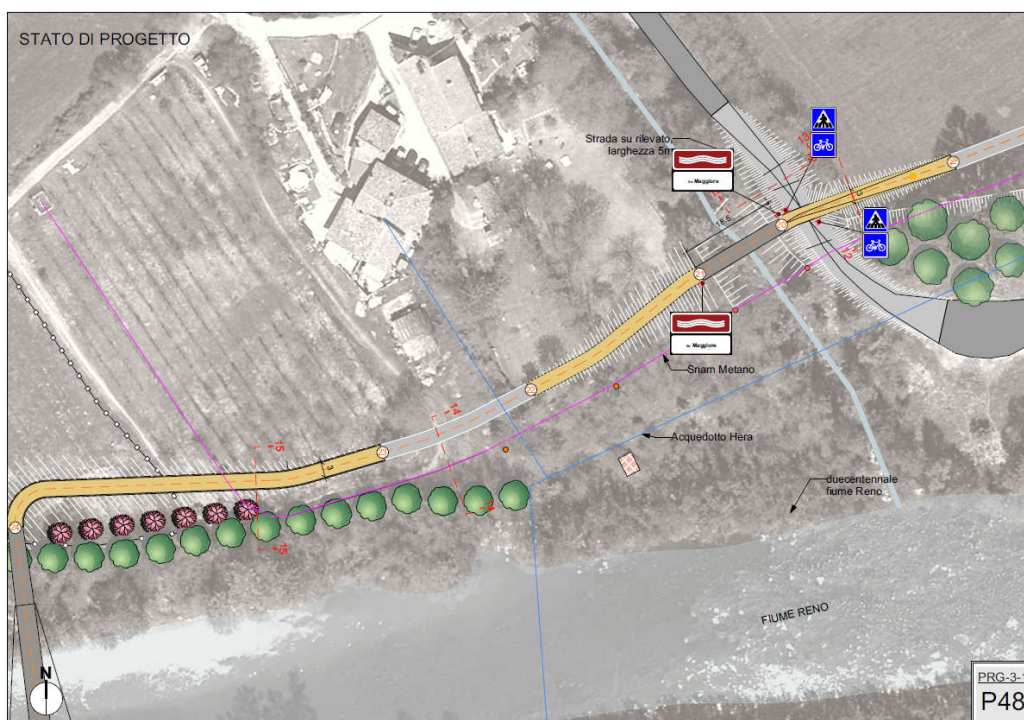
Fosso Rio Maggiore – vista planimetrica della passerella in acciaio
